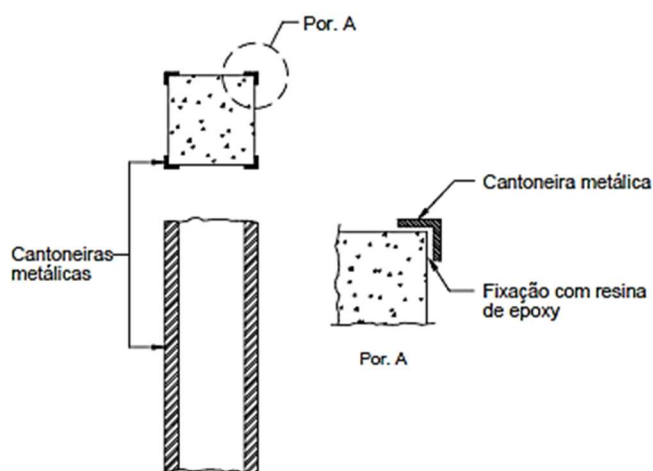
Reforço por introdução de perfis metálicos em pilar [38]
